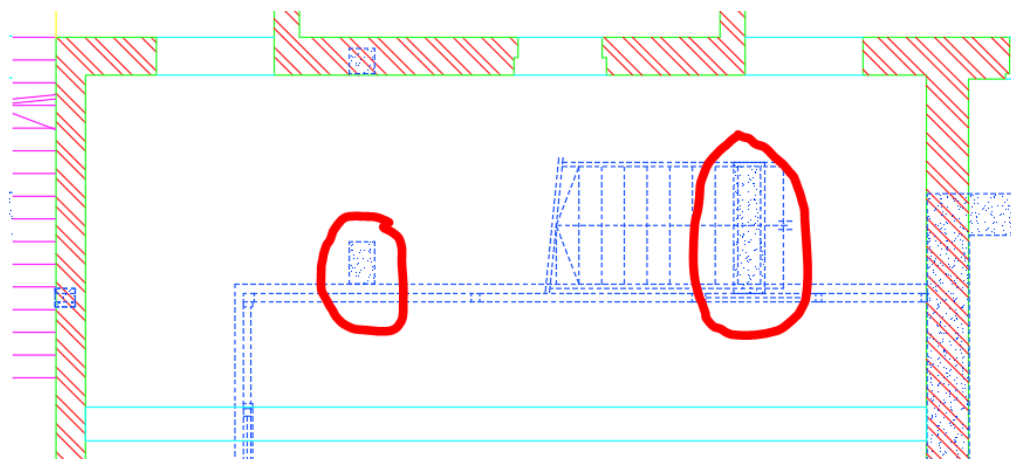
Support du plancher sur le plancher de l'aile Ouest
